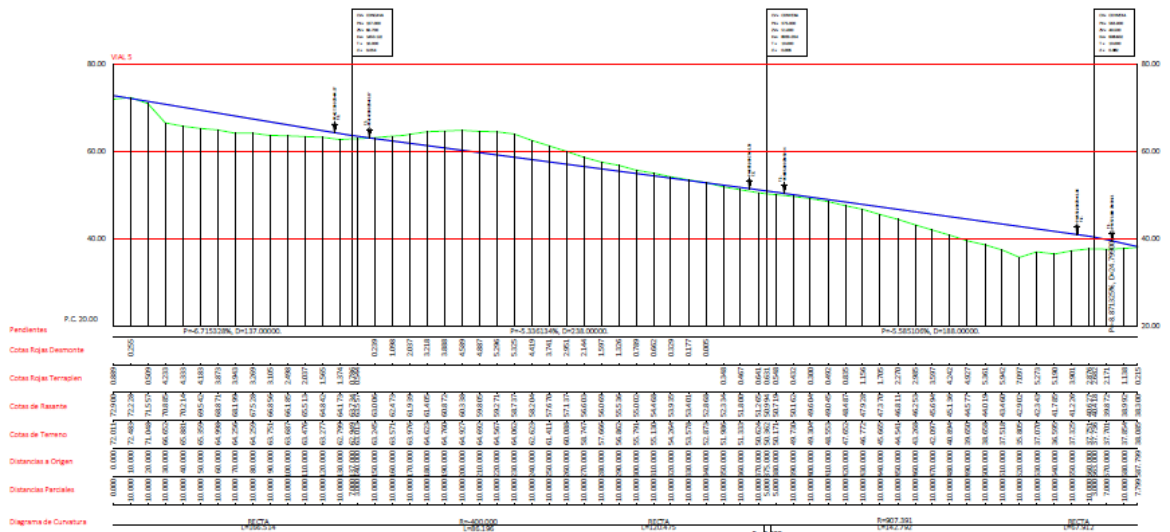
Imagen de la sección longitudinal del vial 5 en la alternativa 2.
